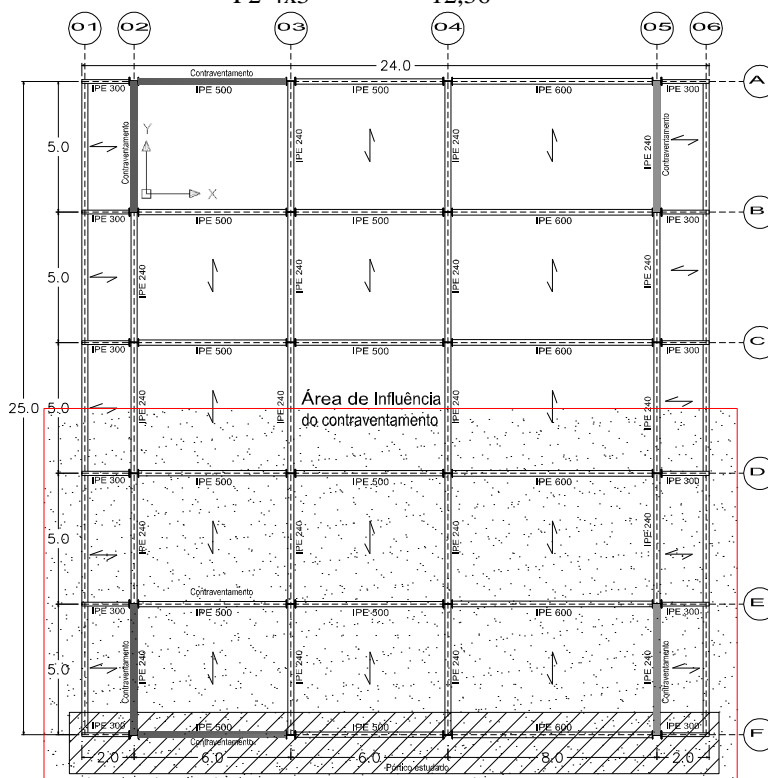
Planta baixa com a definição da área de influência do contraventamento.
